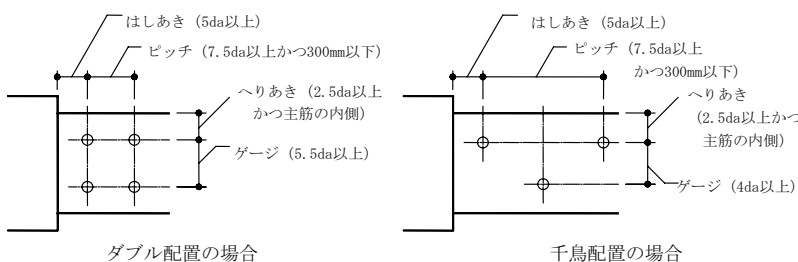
あと施工アンカーの間隔および呼称 2)
